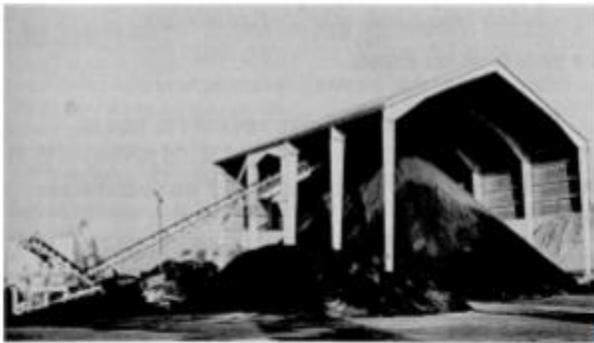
Superficie pavimentada que favorece el drenaje y pila cubierta Randy C. West
